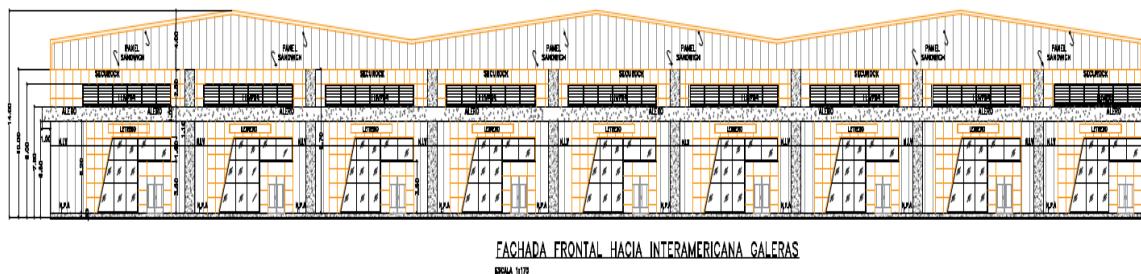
Fachada frontal Galeras. Fuente: Plano del proyecto
